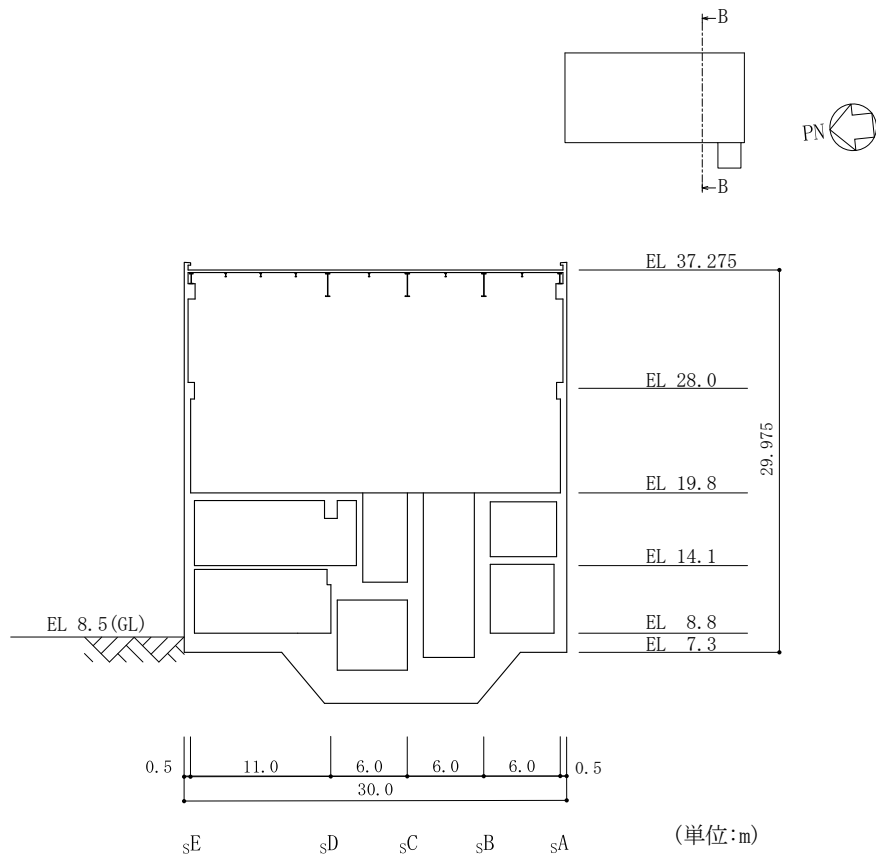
(2) サイトバンカ建物の概略断面図 (B-B 断面, EW 方向)
